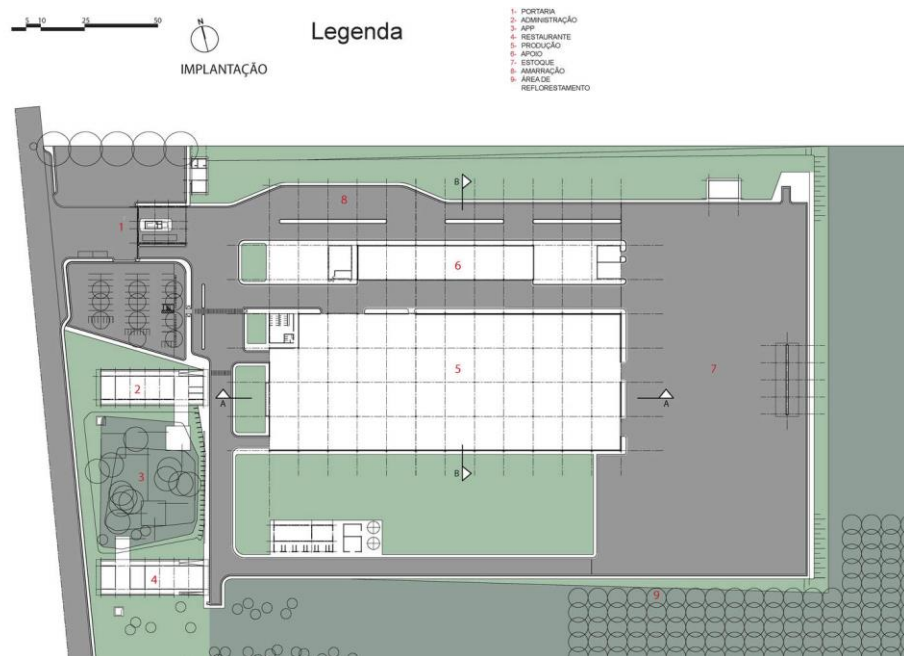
Planta baixa Brasilit Saint-Gobain Seropédica
